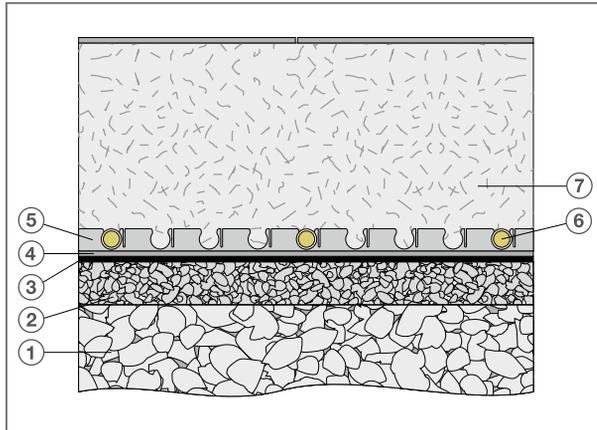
Aufbauvariante mit Stahlfaserbeton
